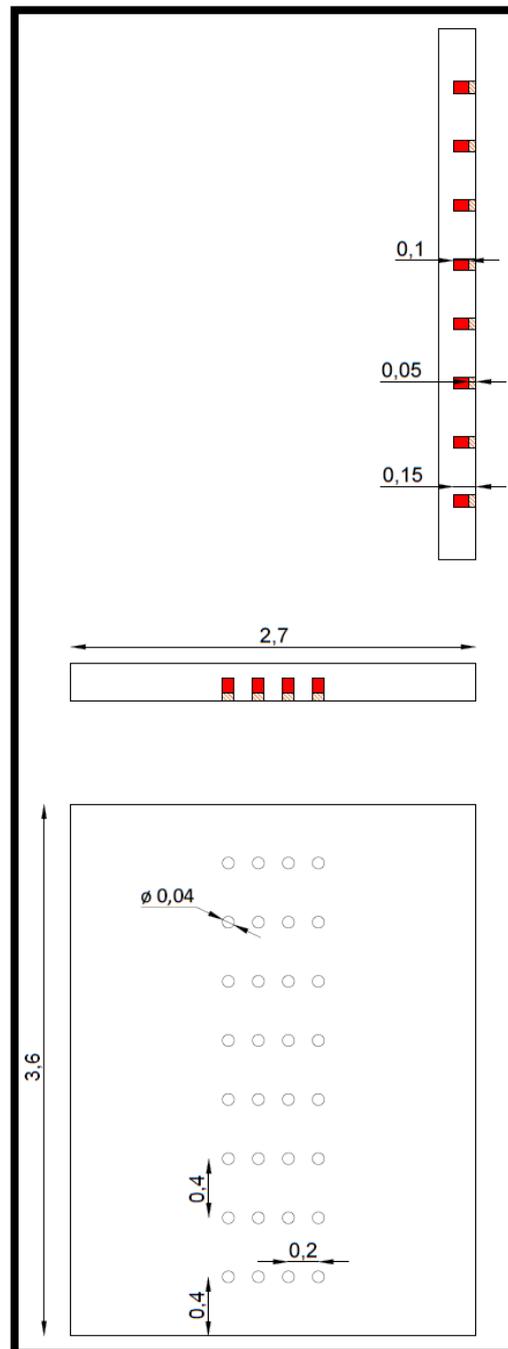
Alzado, perfil y planta del “Muro de carga de las Escaleras”.
